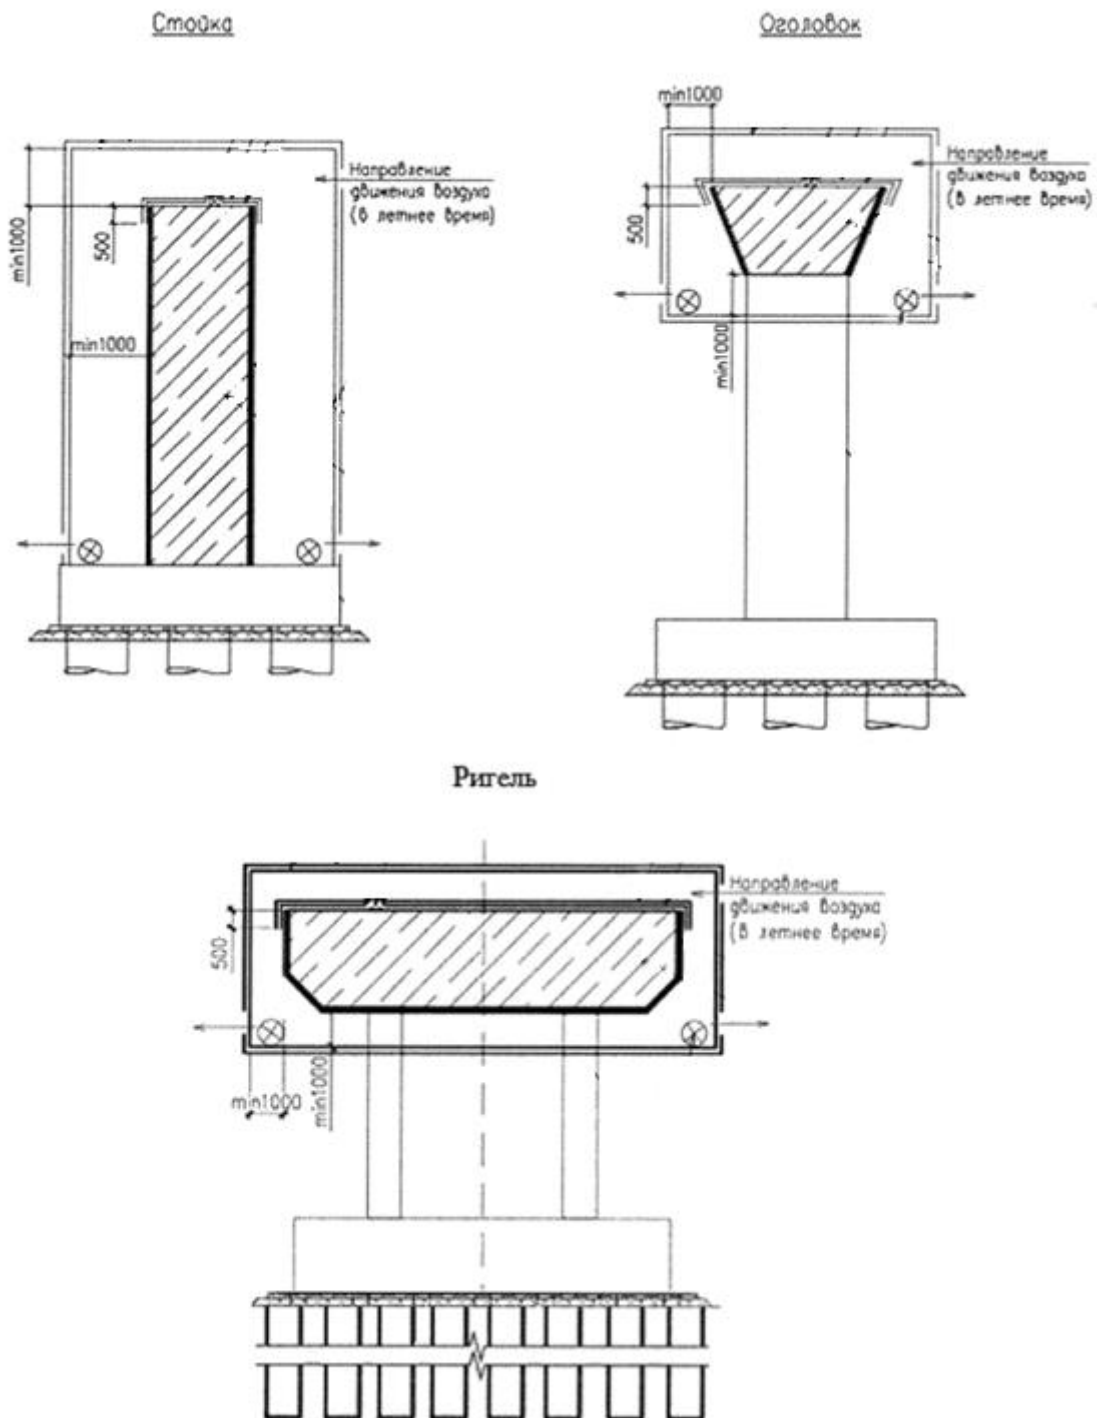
Принципиальная схема конструкции тепловлажностного покрытия и укрытия для конструкции опоры
